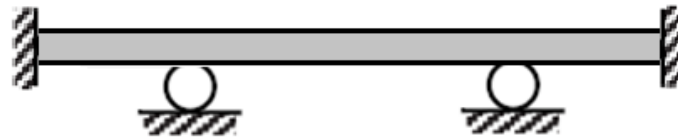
Viga doblemente empotrada y apoyada (Flores, 2018).
